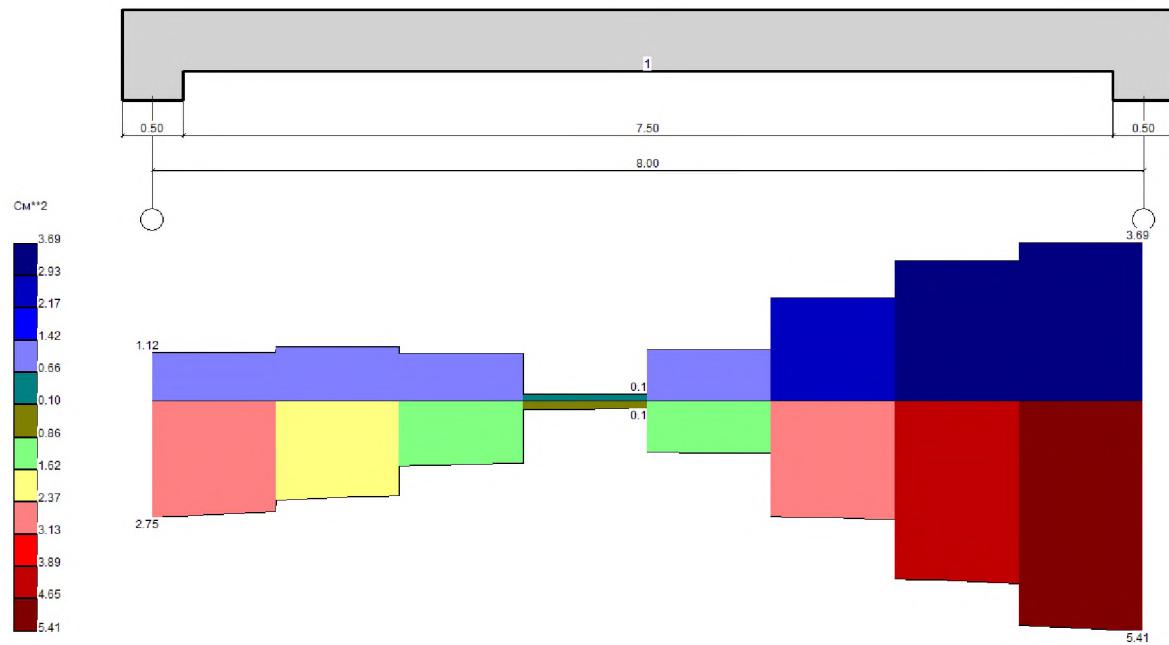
Балка № 9. Епюра поперечного армування
